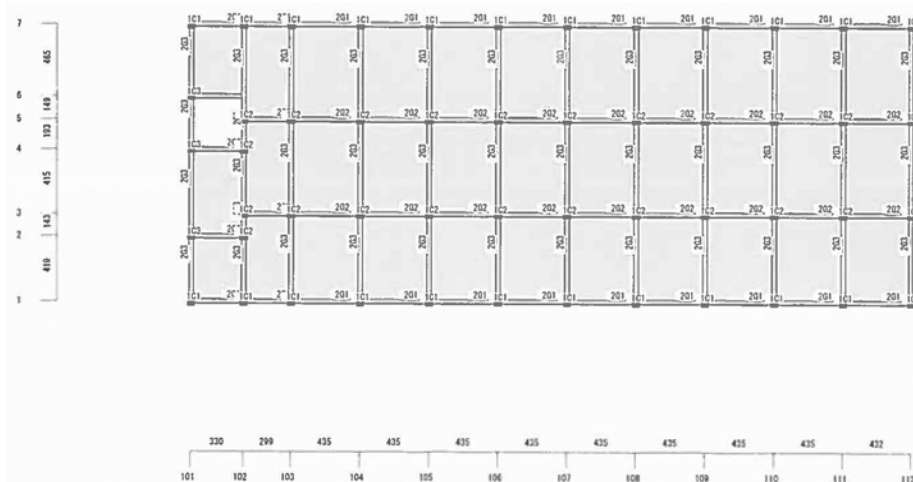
Dibujo de muestra de un plan de encuadre estructural
